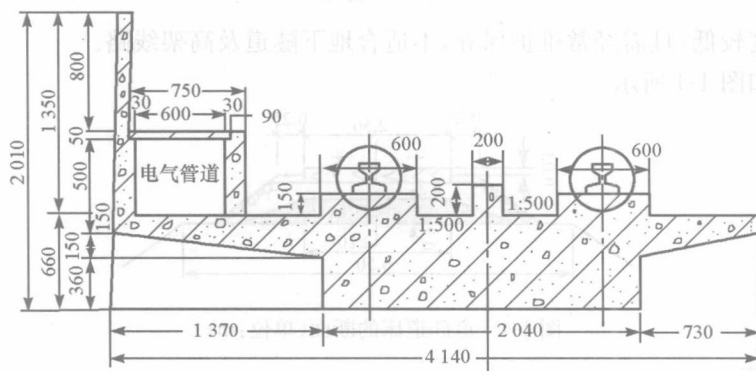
高架混凝土桥无砟轨道结构(单位:mm)
